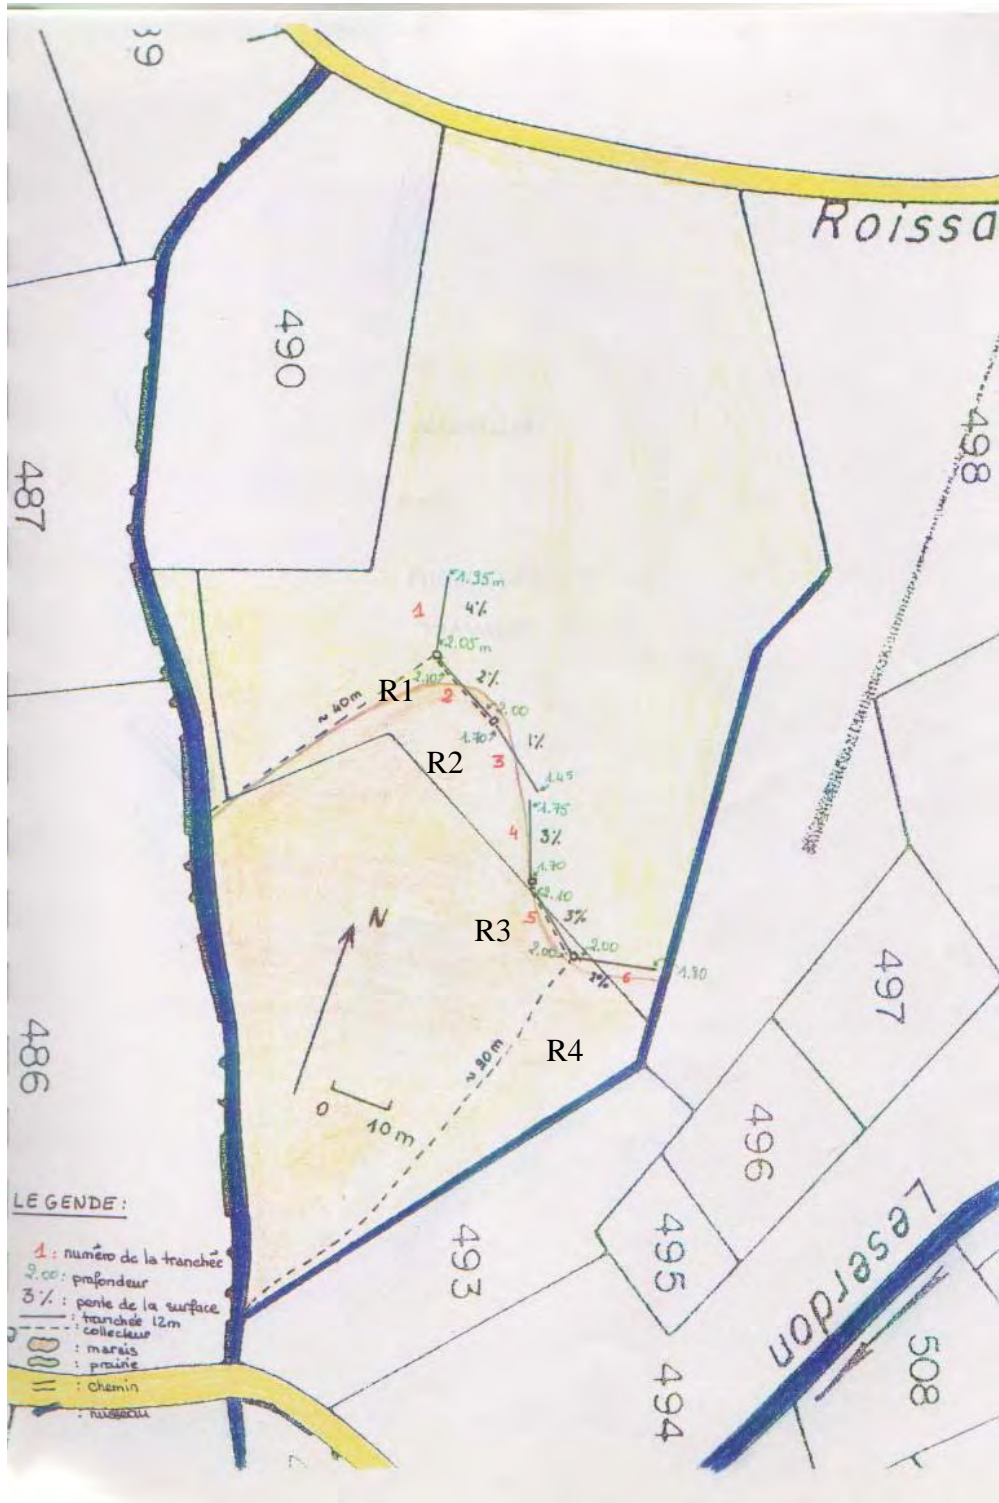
Plan du site après travaux, d'après LEROY J. (1993)
